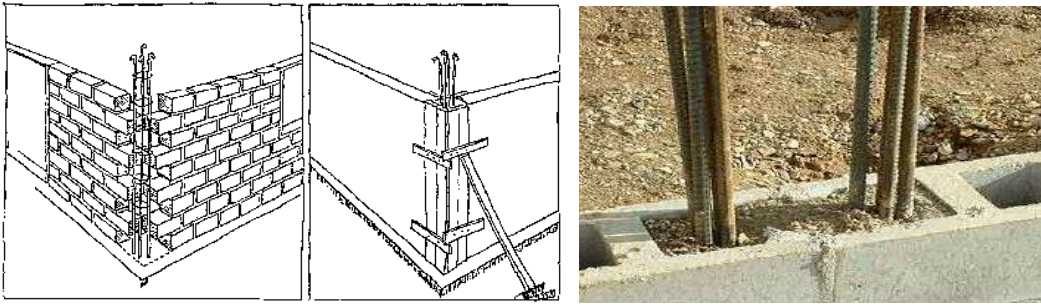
Disa nga brezat betonarmë si dhe hojet e mbushura me beton të armuar.
